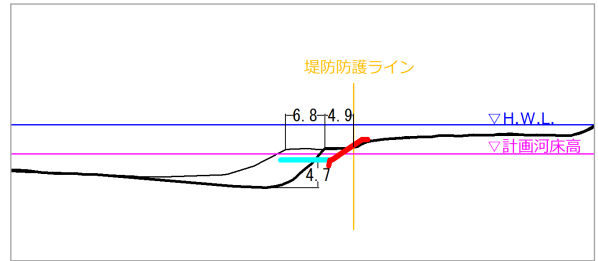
検討対象護岸② CIMモデルから抽出した横断面図
